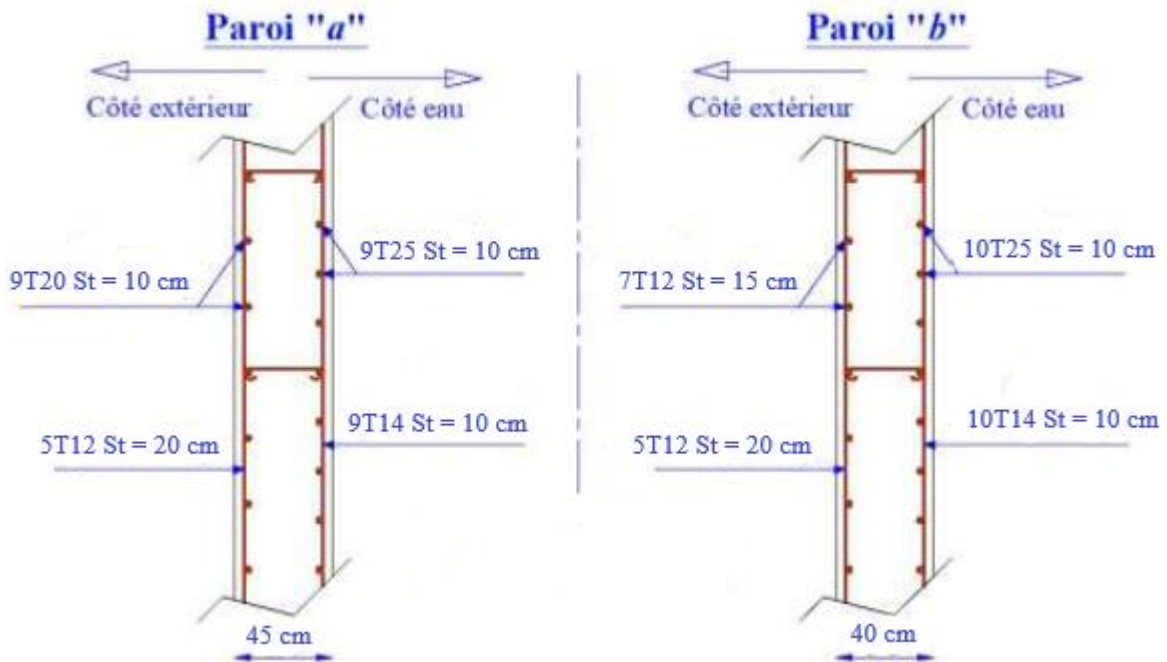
Schémas de ferrailage des parois de la bache à eau.
